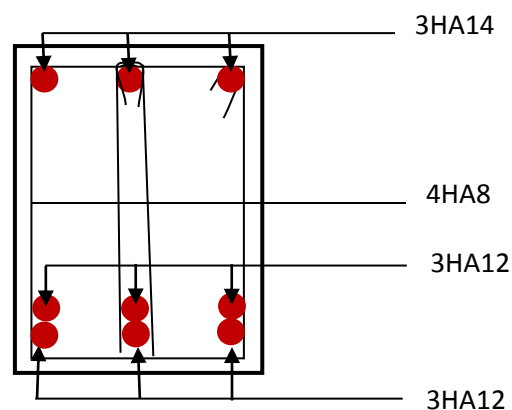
Ferraillage en travée d'une poutre secondaire
